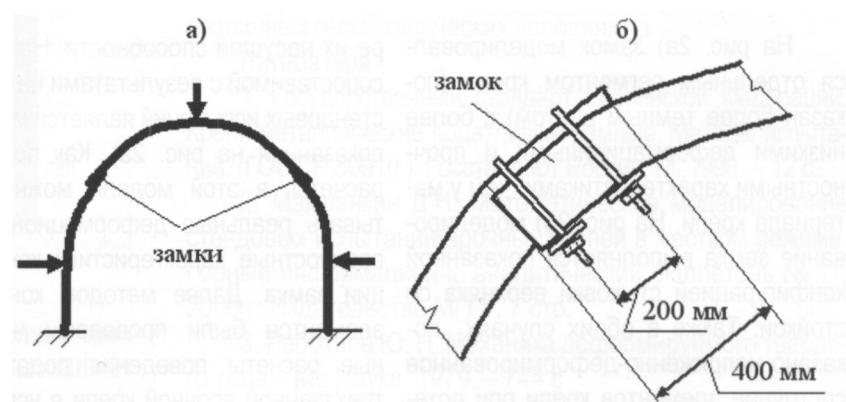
Схема трехзвенной податливой крепи и ее стендовых испытаний (а); место соединения звеньев (б)
